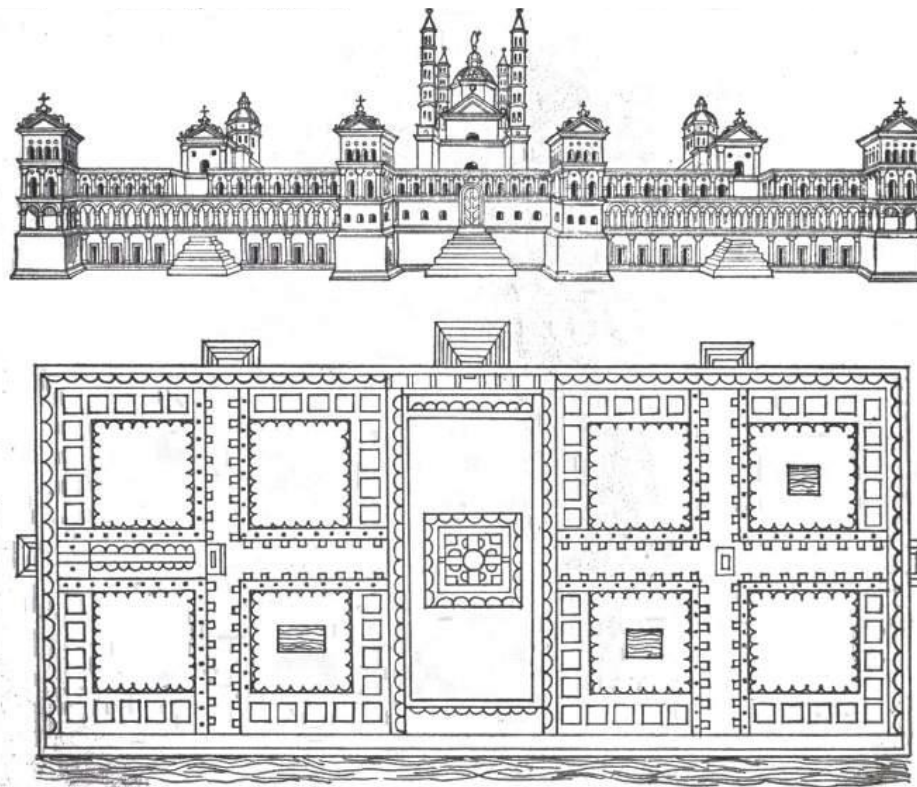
Prospetto e pianta del Ca' Granda di Milano (Fonte: AA.VV., 1981).
